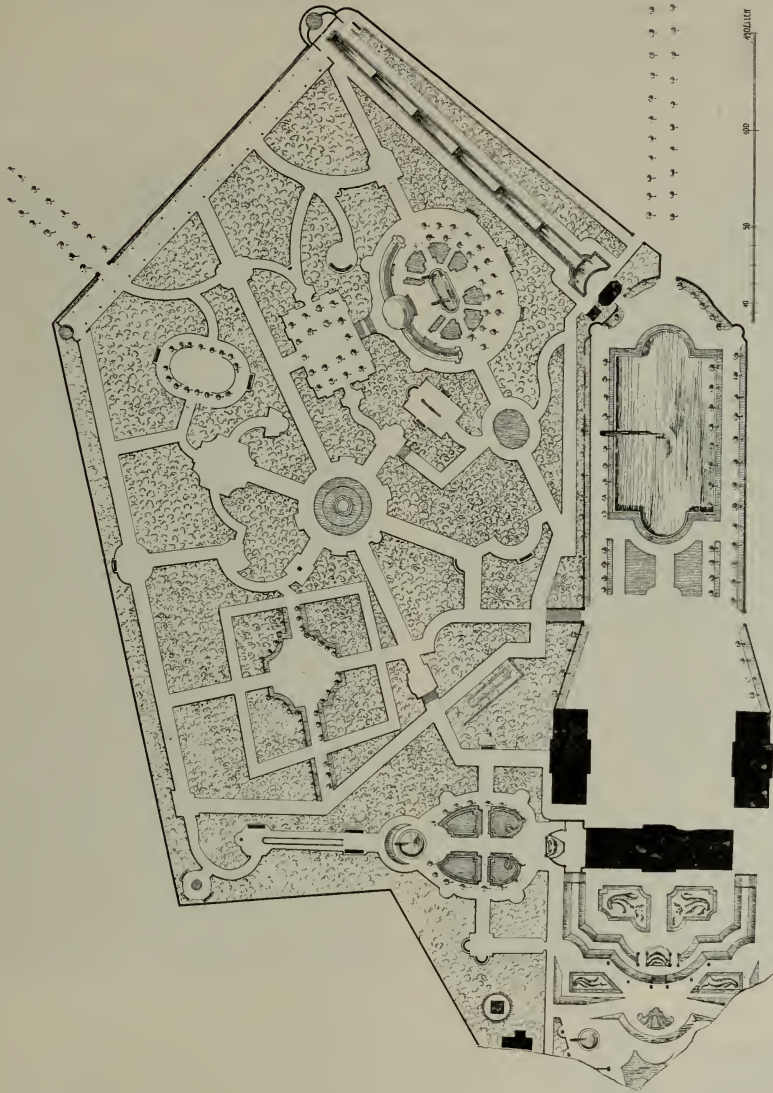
Oberlichtenau, Schloß, Lageplan.
